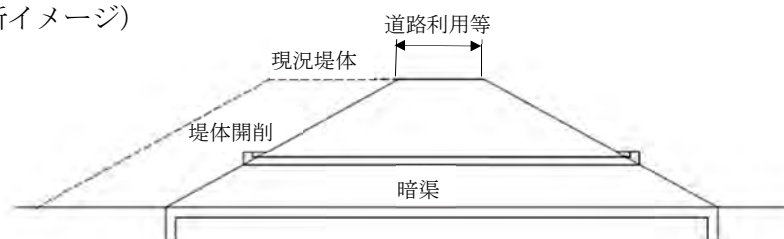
堤体開削工法と埋立工法の複合工法の事例
